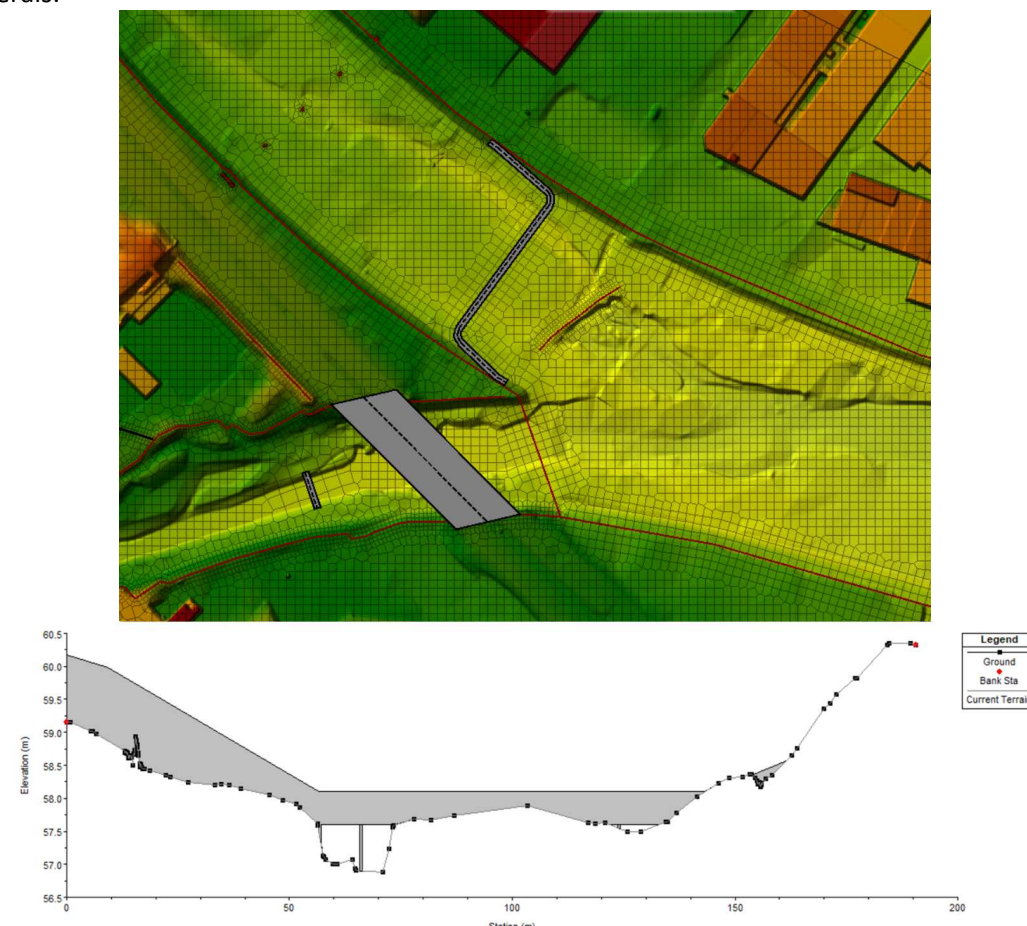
Ubicació en planta i secció del nou gual projectat al riu Ripoll.
